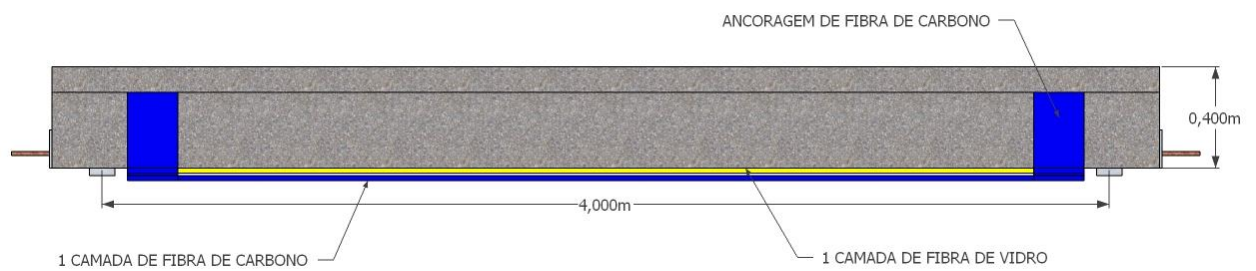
Configuração de colagem da fibra viga VA4 - VC
